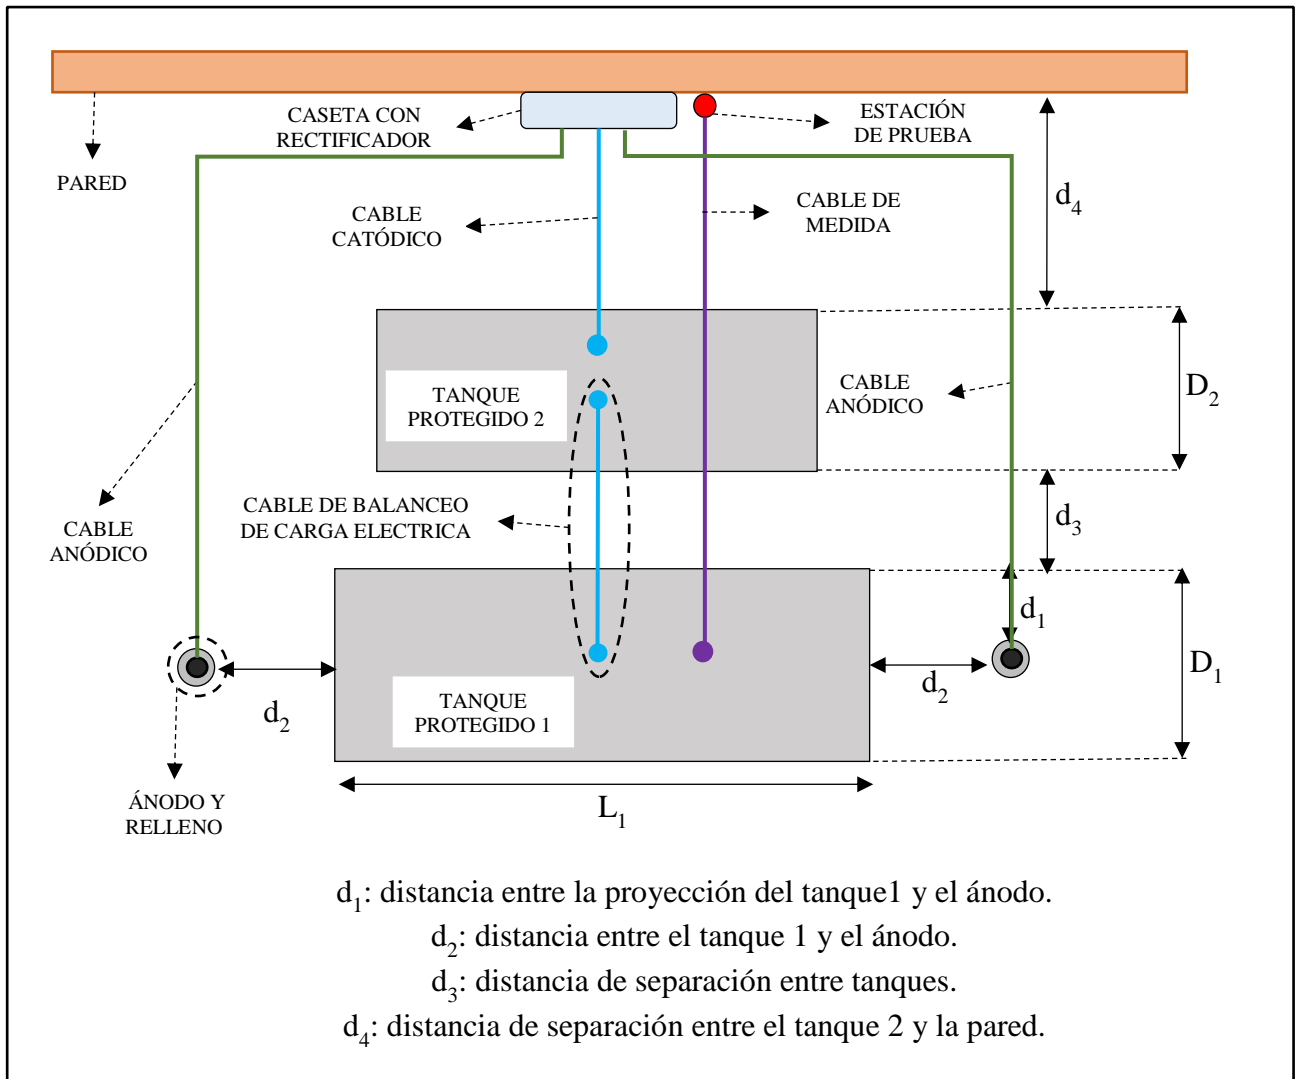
Vista de planta de un sistema de protección con sus respectivas distancias de ubicación.
